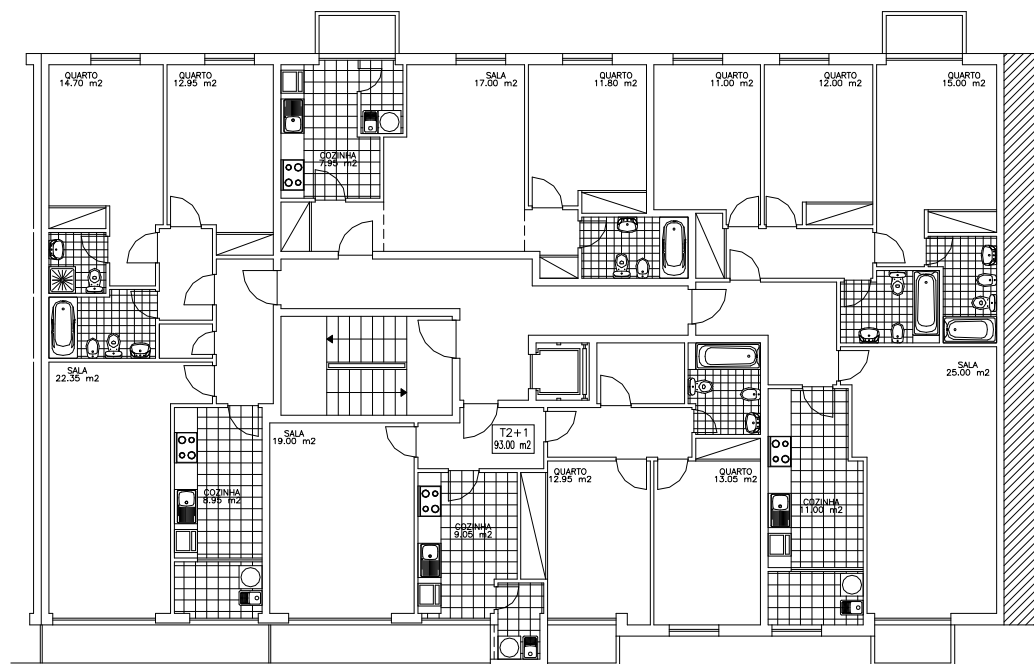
Planta do 1º, 2º e 3º pisos
